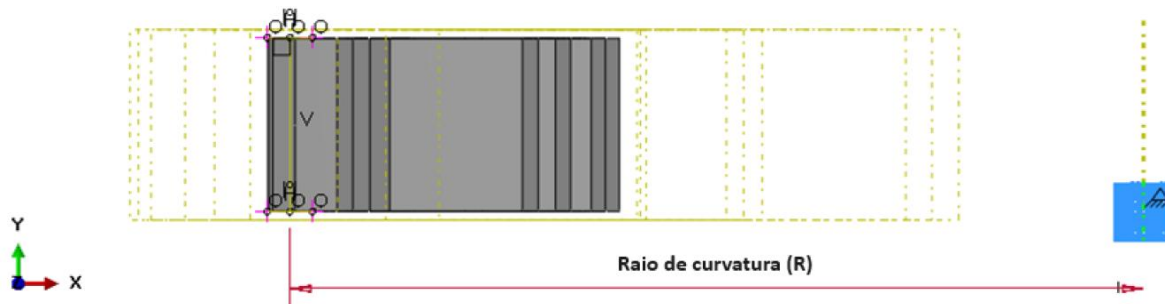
Técnica de revolução aplicada ao perfil I das vigas modeladas numericamente.
